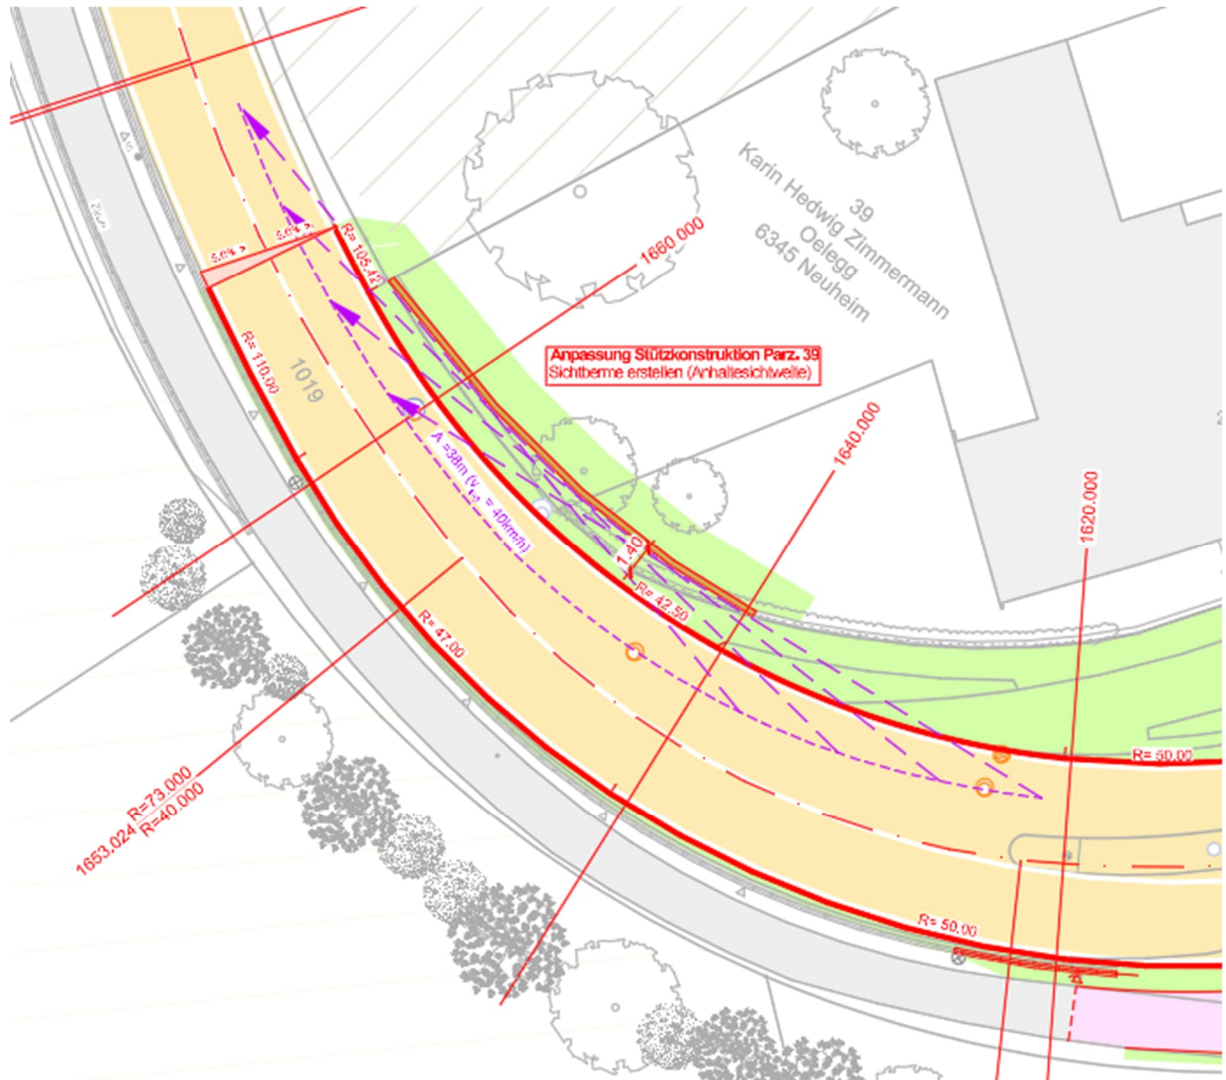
, Ausschnitt Strassenbauplan (Quelle: Eichenberger AG)
